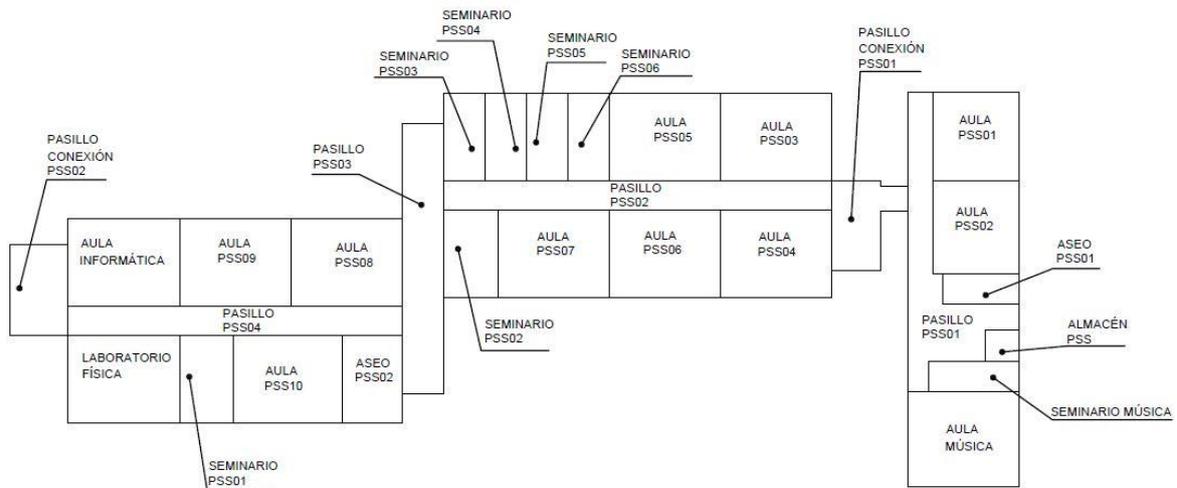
Distribución de los espacios de la segunda planta del instituto.
